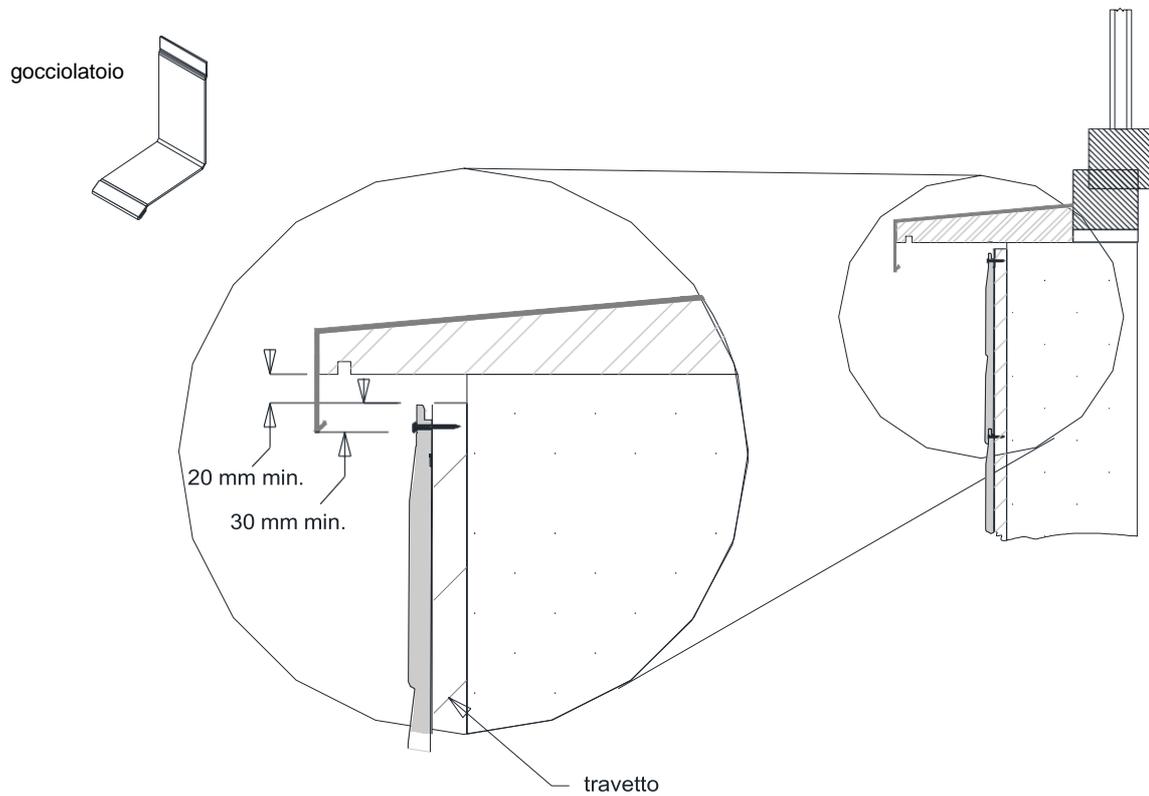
Sostegno - Posa diretta (sezione verticale)
